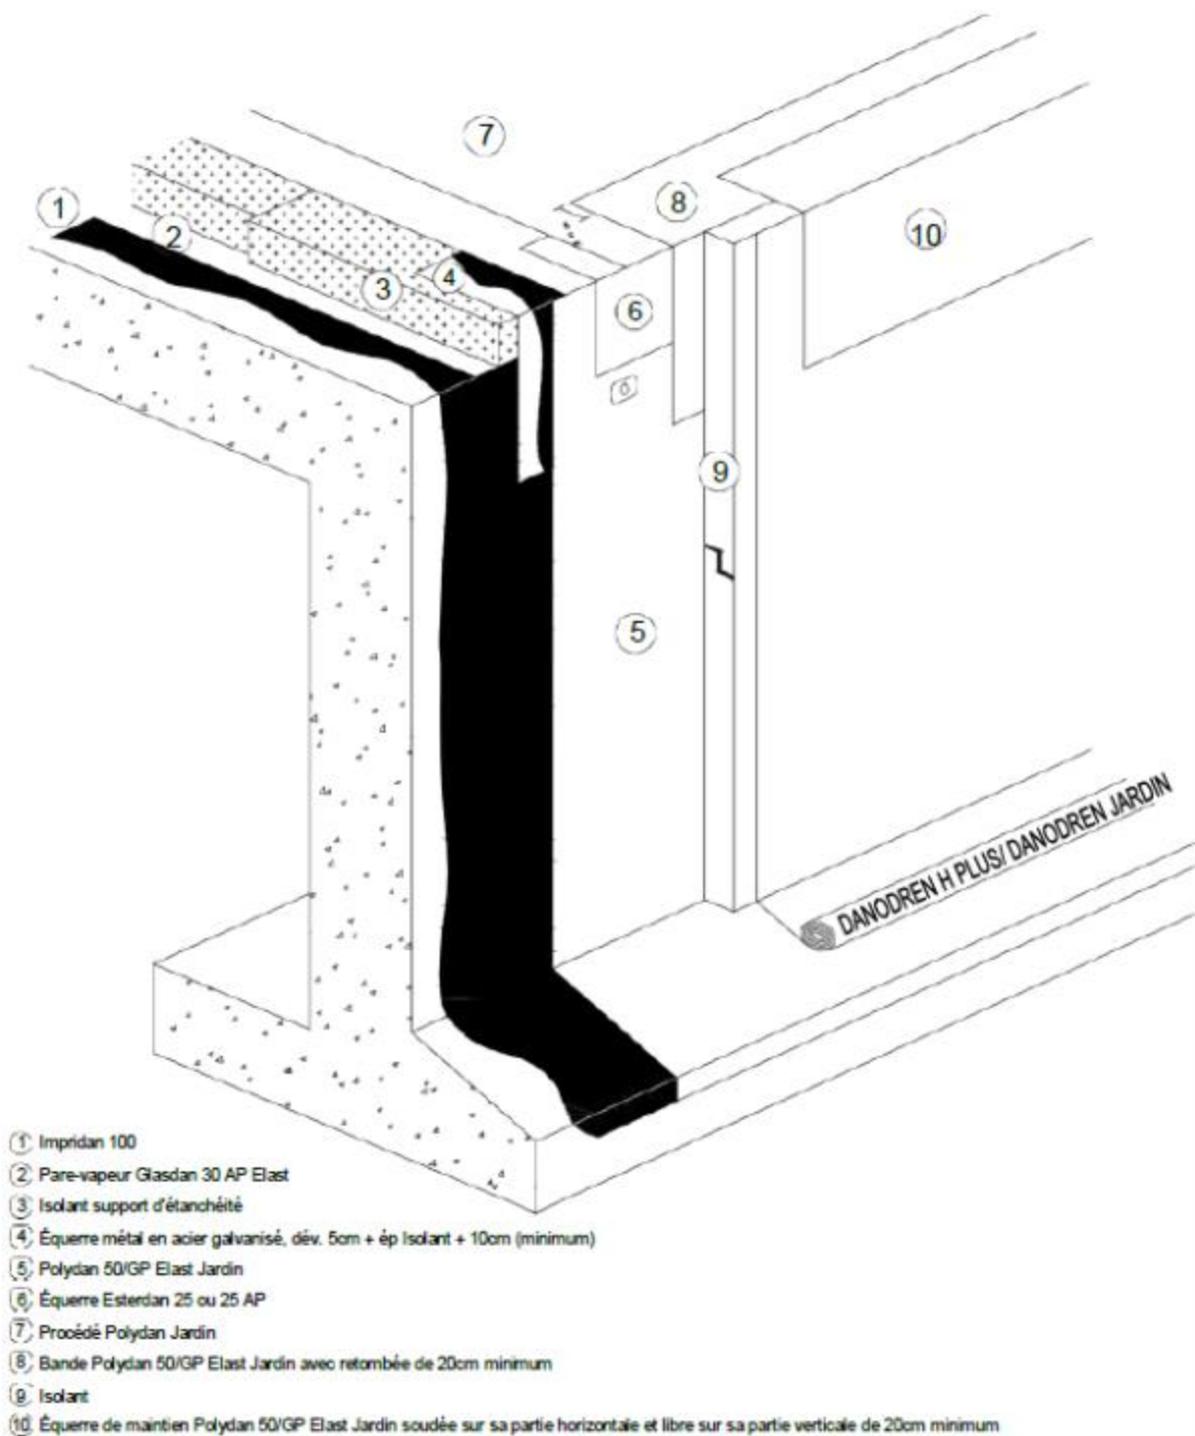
Exemple de retombée – sur maçonnerie isolée et étanchée
